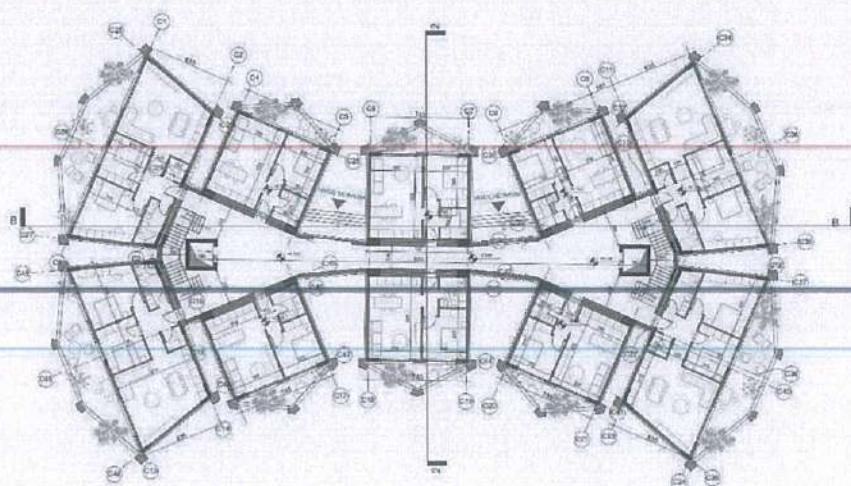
Plani i katit 0 dhe +1\_Palazzina 3
